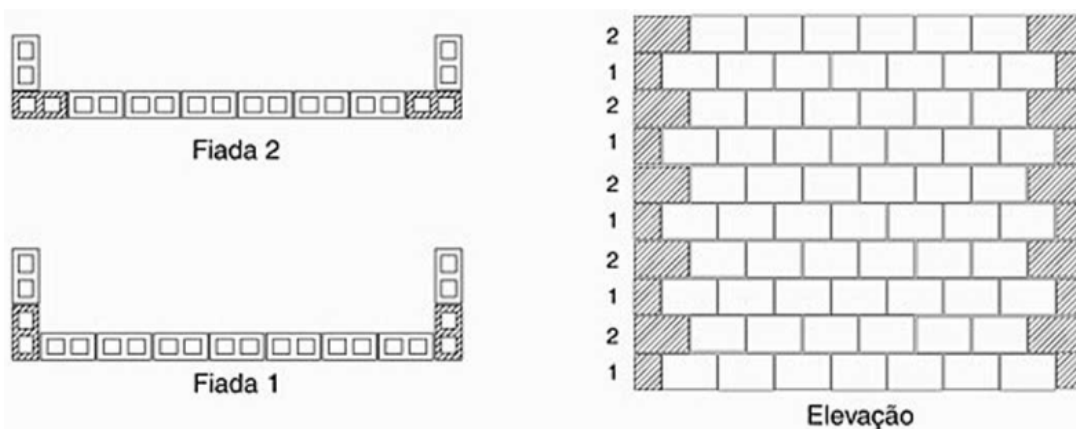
Vista em planta e elevação de uma parede, (Ramalho e Corrêa 2003).
